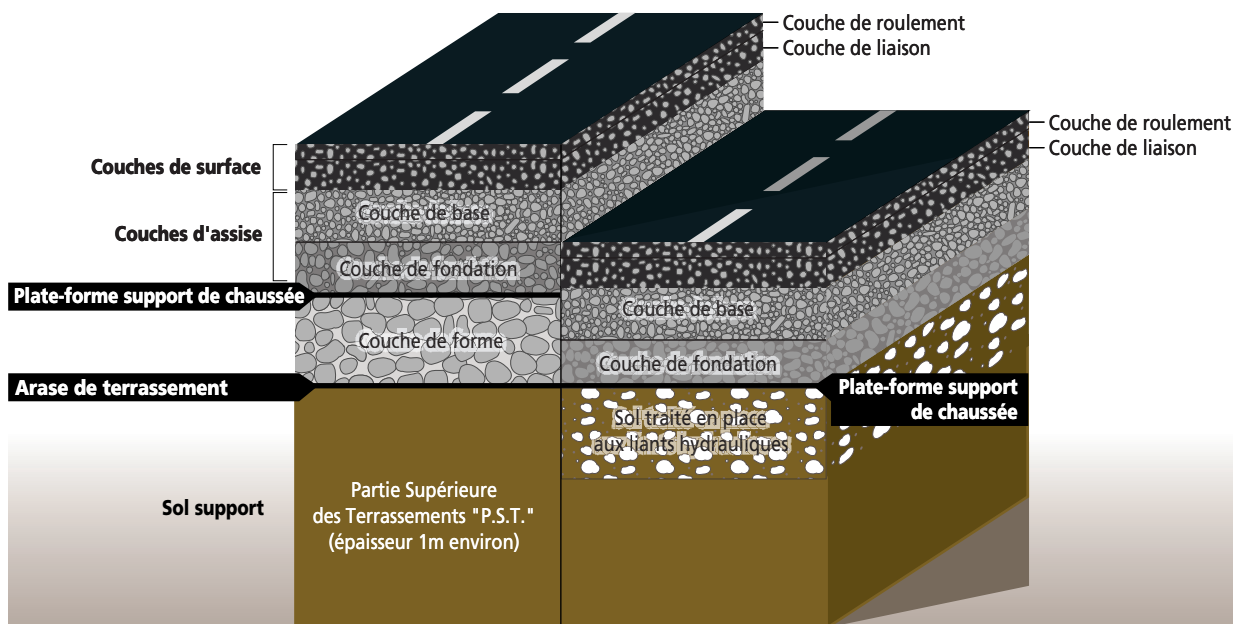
Les différentes couches qui constituent la structure de la chaussée
